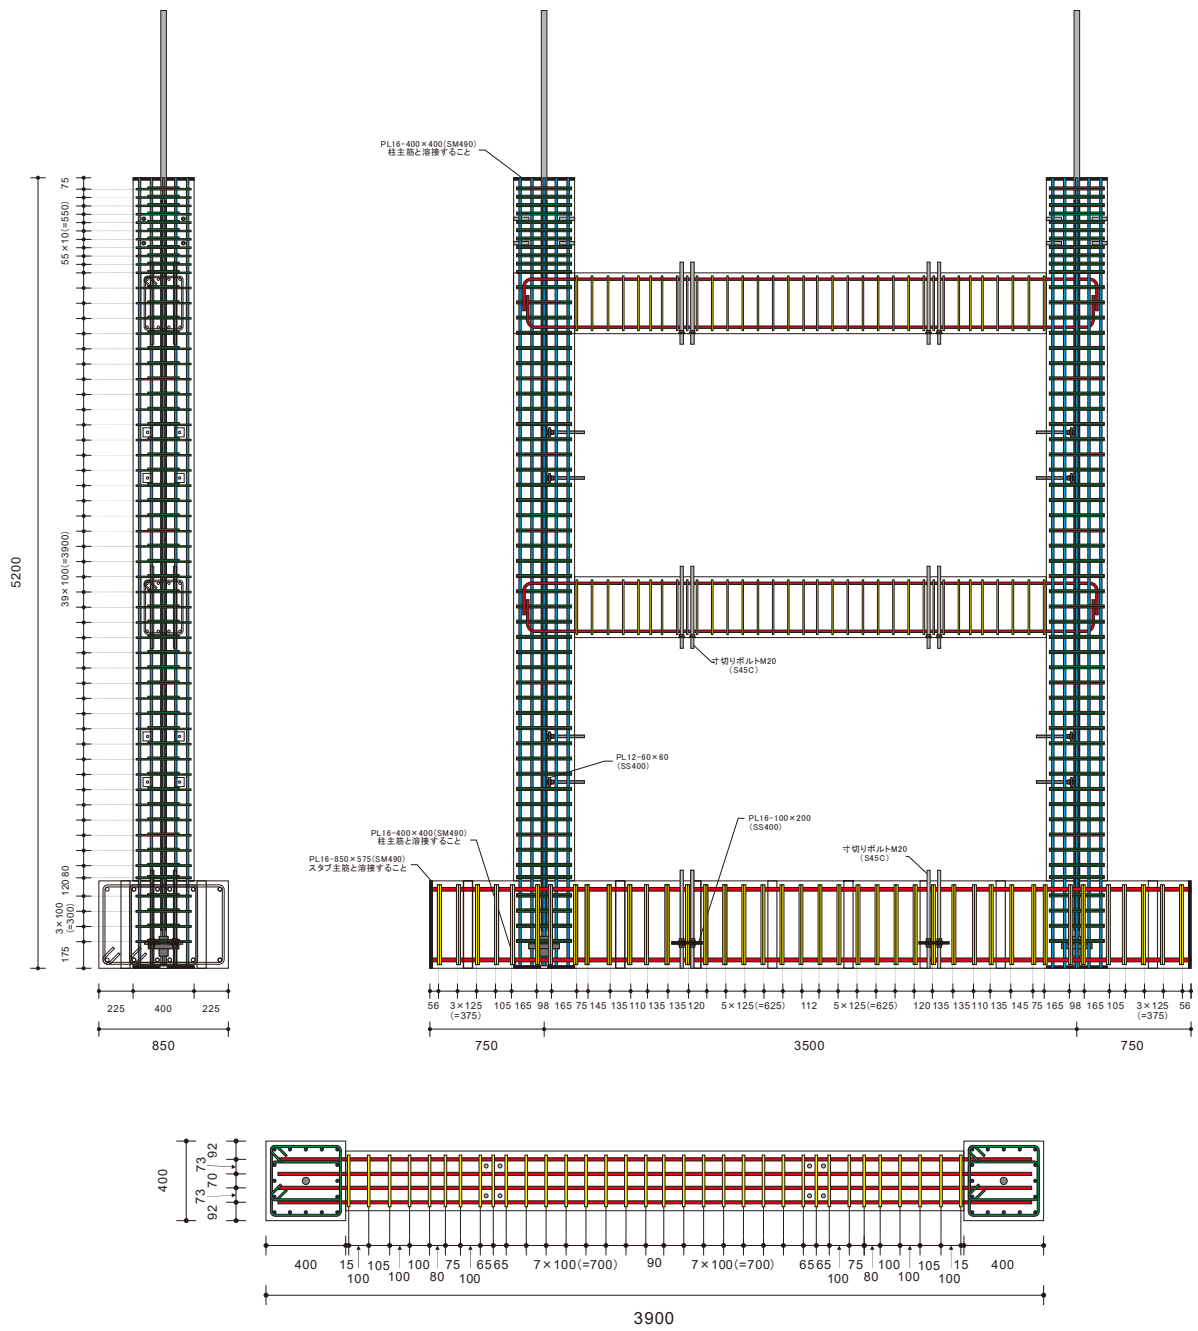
試験体 B の RC 部分の配筋図 (単位:mm)
